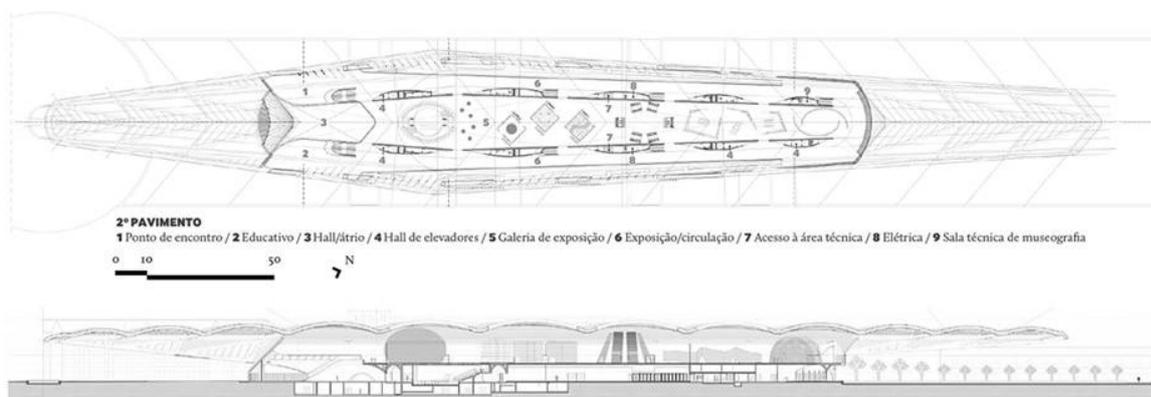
Museu do Amanhã: Planta do pavimento expositivo e corte longitudinal.
